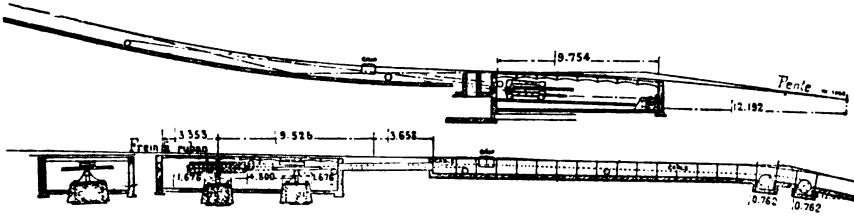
Installation à équilibrage de voitures de San Francisco. — Disposition des poulies aux extrémités de la rampe.
